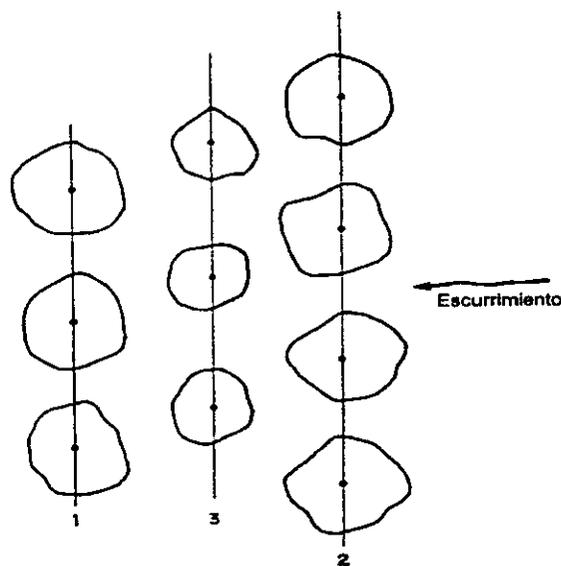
Presentación esquemática de la técnica de inyección con tres líneas.
